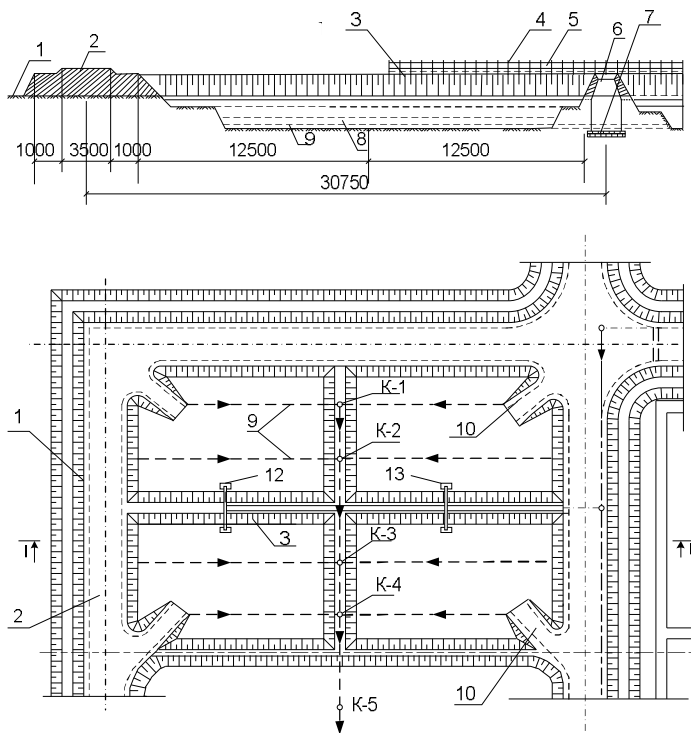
Иловые площадки (план, разрез 1-1):
